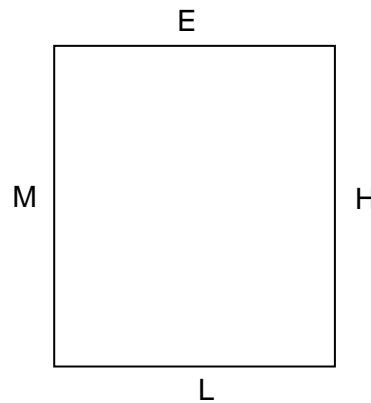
Vista em planta (esquema) e identificação das faces/alçados por E, L, H, M.
